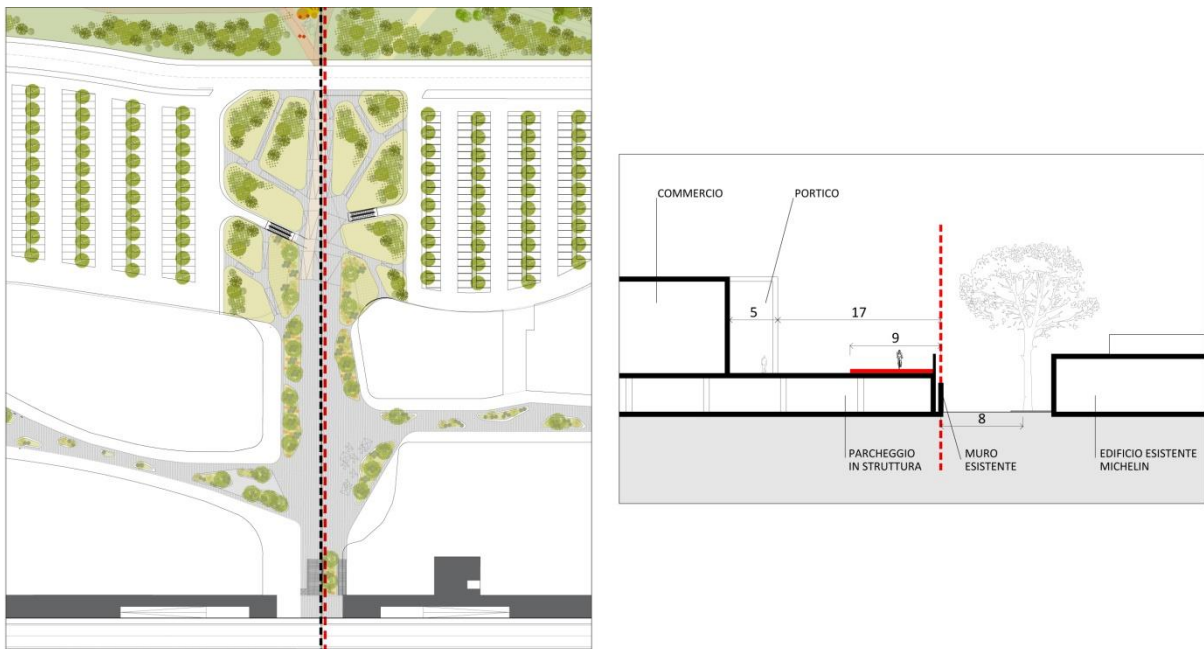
Ipotesi separatore pubblico – Pianta e sezione
